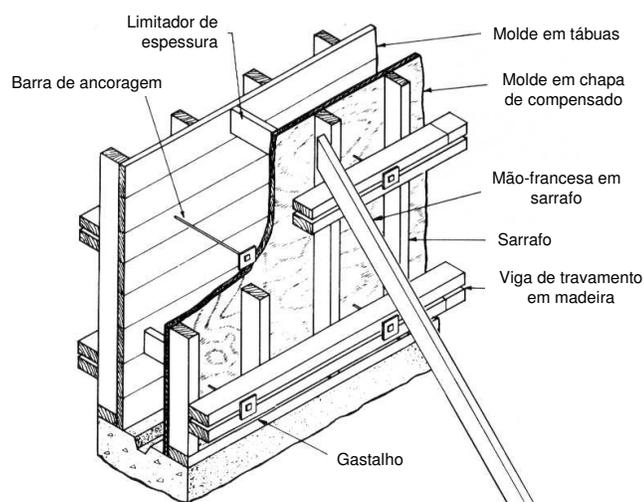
Esquema genérico de fôrma para parede utilizando o sistema tramado (PETERS, 1991).
